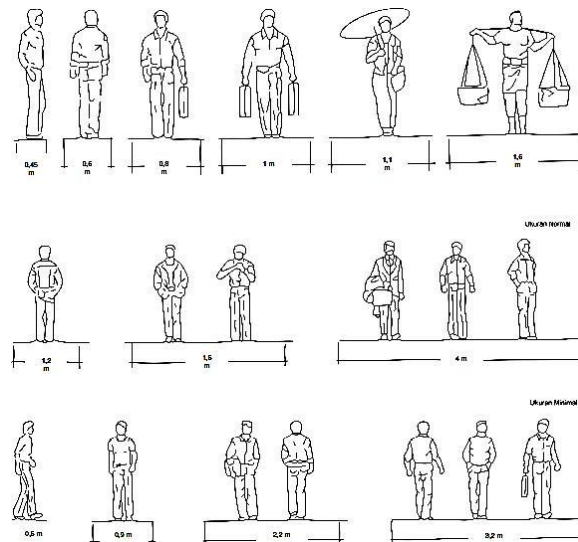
Jalur pada Ruas Pejalan Kaki
